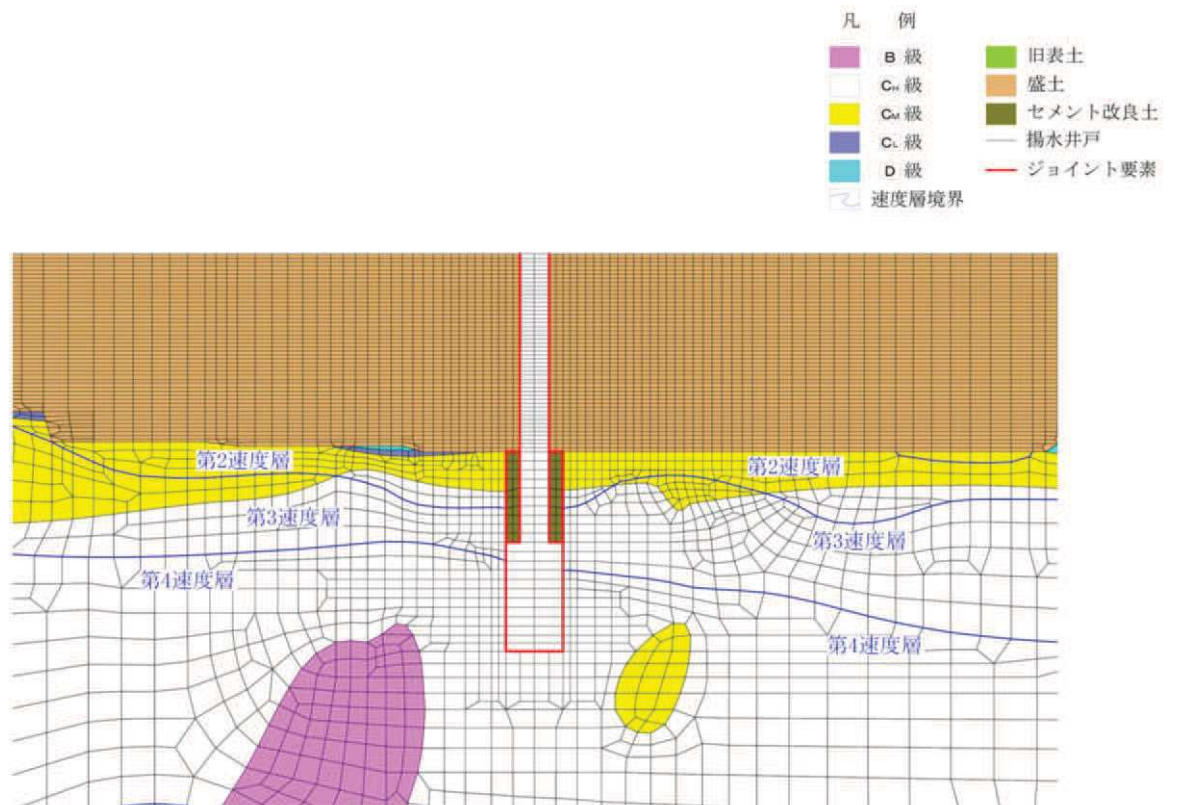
(2) ジョイント要素の配置図 (No.2 揚水井戸)
